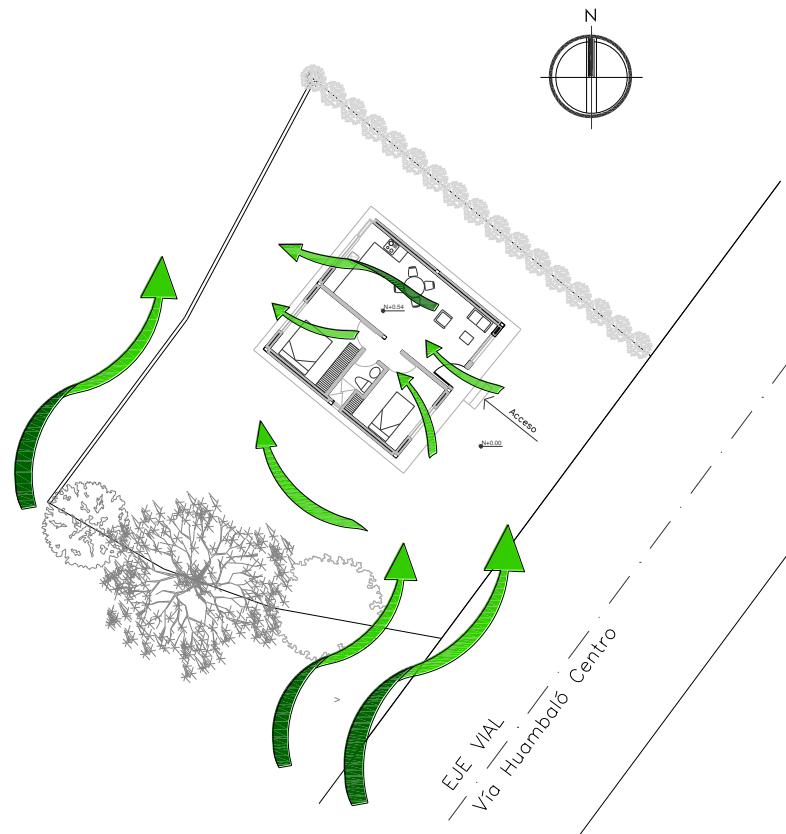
Ventilación cruzada – propuesta vivienda existente Huambaló
